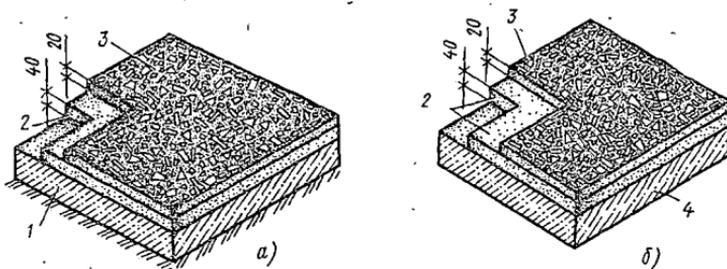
Конструктивные схемы полимерцементно-бетонных полов, уложенных на грунте (а) и на междуэтажном перекрытии (б):
